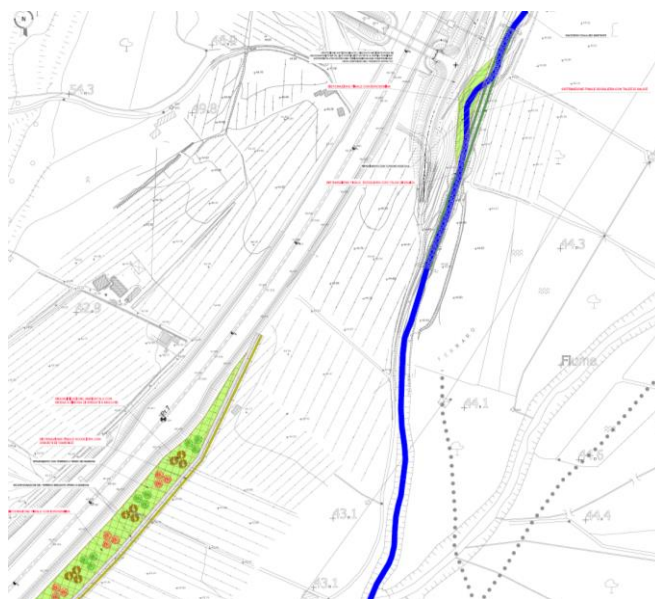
Planimetria interventi di progetto – tratto a monte viadotto Mesima 4
